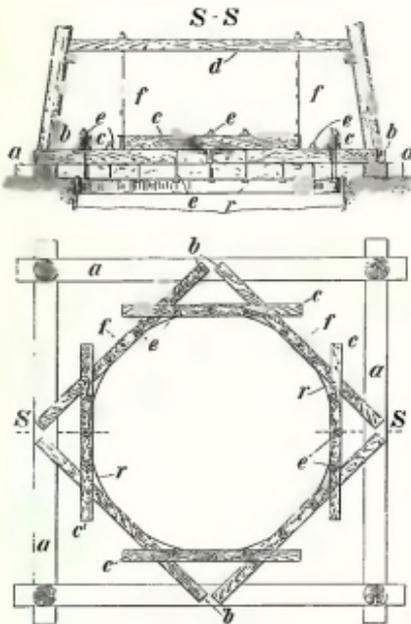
Aufhängung des ersten Ringes unmittelbar unter der Tagesoberfläche.
